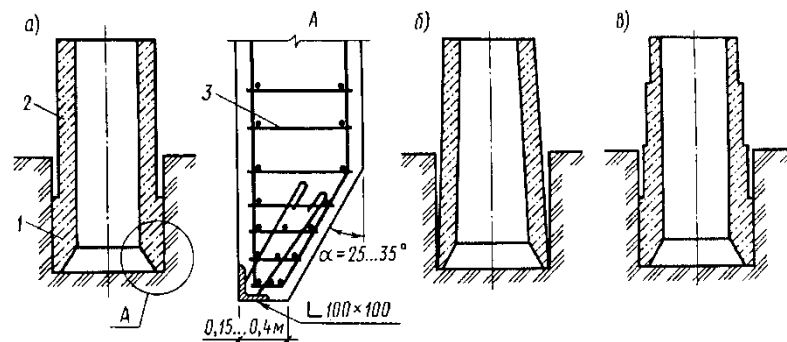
Форма вертикальных сечений монолитных опускных колодцев:
